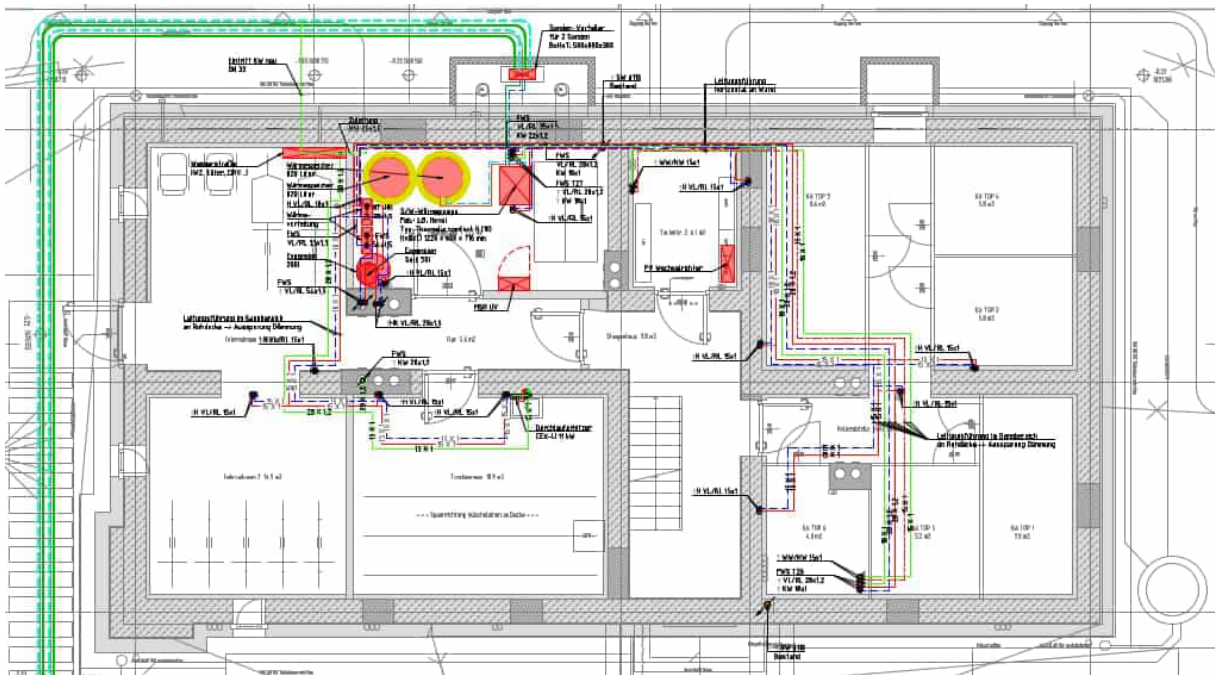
Grundriss Kellergeschoß kleines Gebäude mit Haustechnikraum; Planungsteam E-Plus
